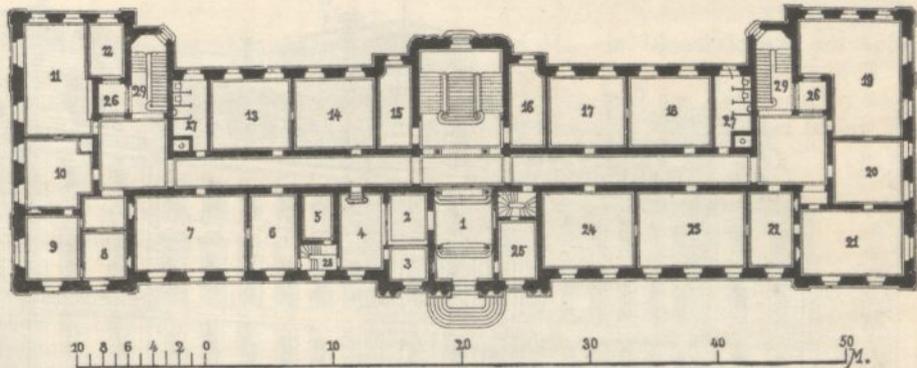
Verwaltungsgebäude der Eisenbahn des Berner Jura zu Bern. Erdgeschoss (Architekt Fr. de Rutté). §
